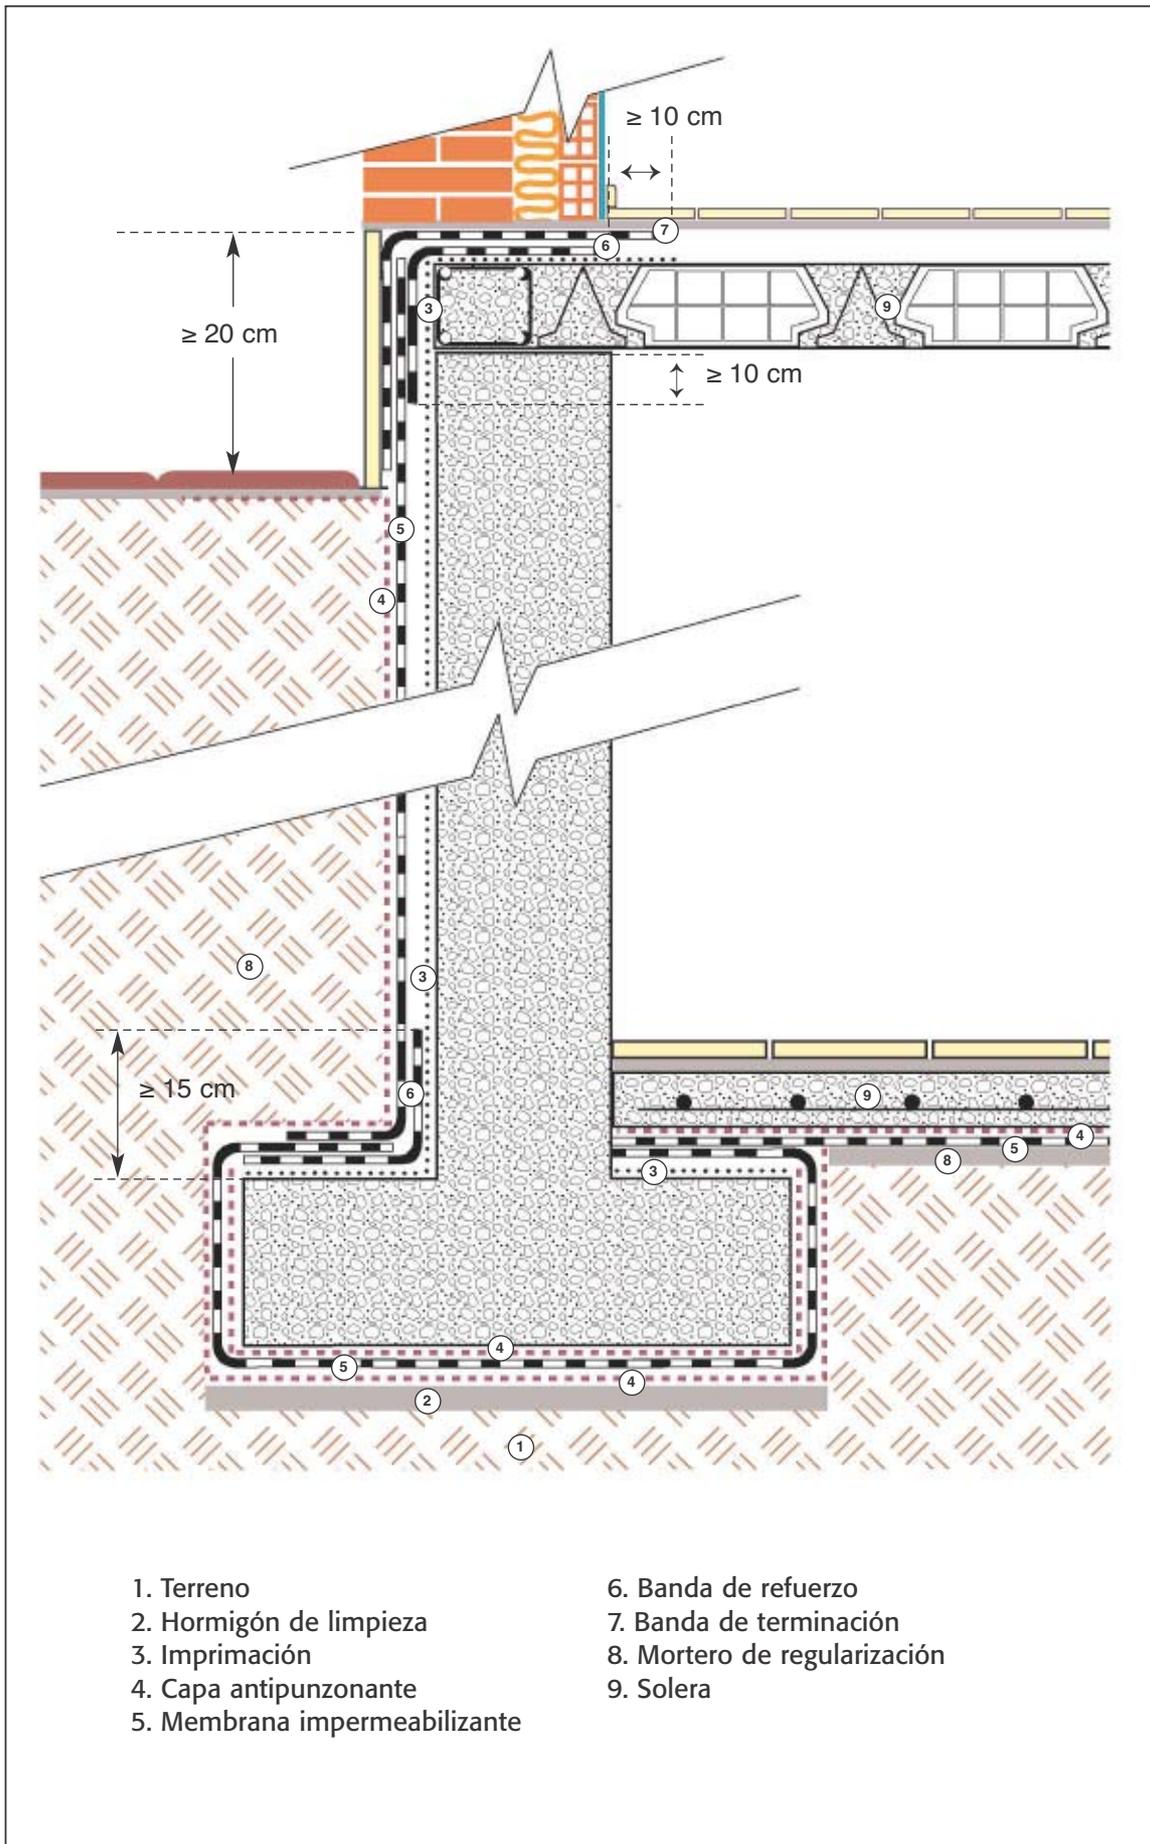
Impermeabilización de cimentación, muros de sótanos y solera
